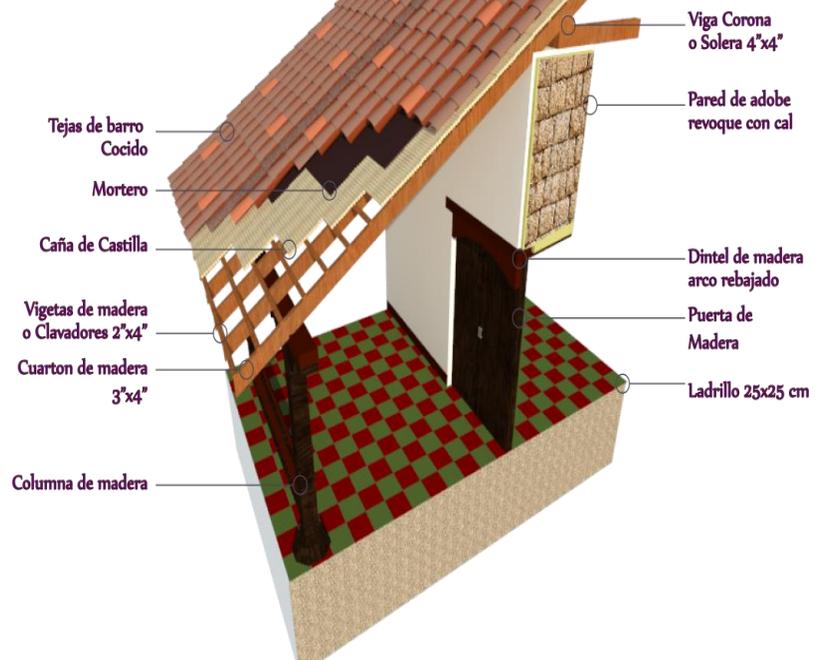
Materiales de construcción de la Casa Hacienda Santa Úrsula.
